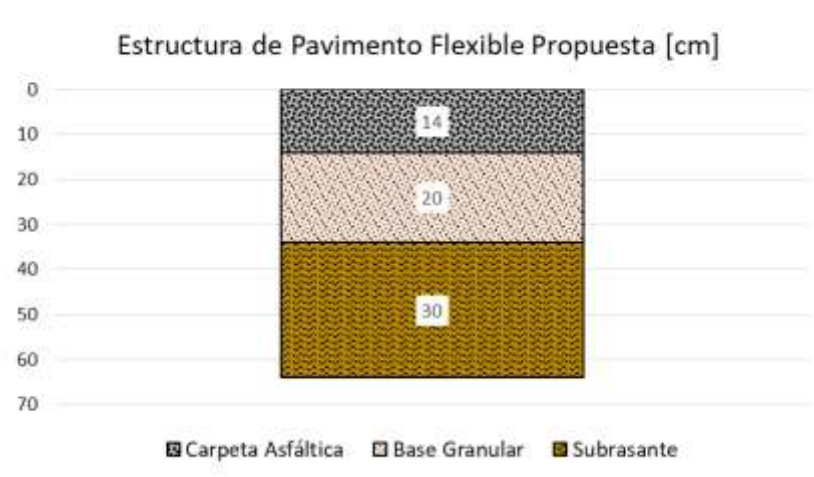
Estructura de Pavimento Flexible Propuesta
